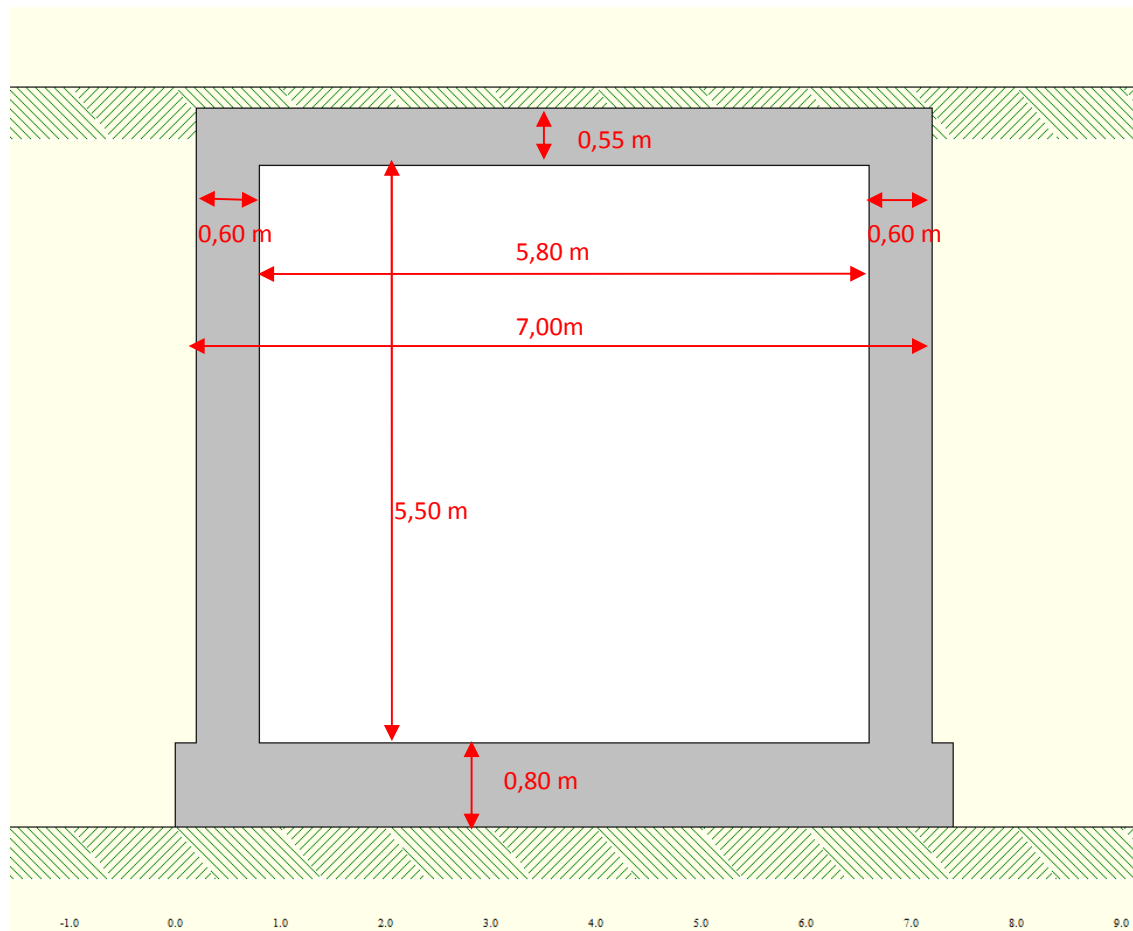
Sezione tipo calcolo (Scat - Atzec)
